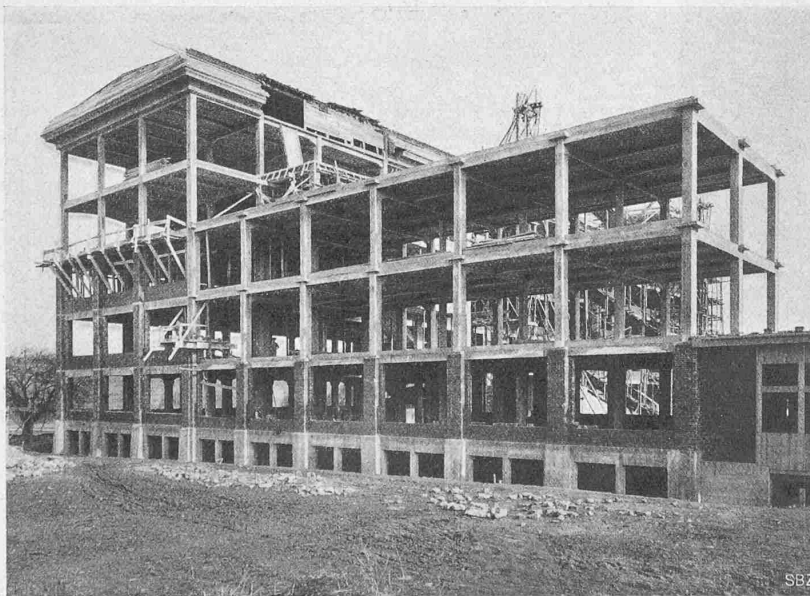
Eisenbeton-Gerippe des Lagerhausflügels im Rohbau.
